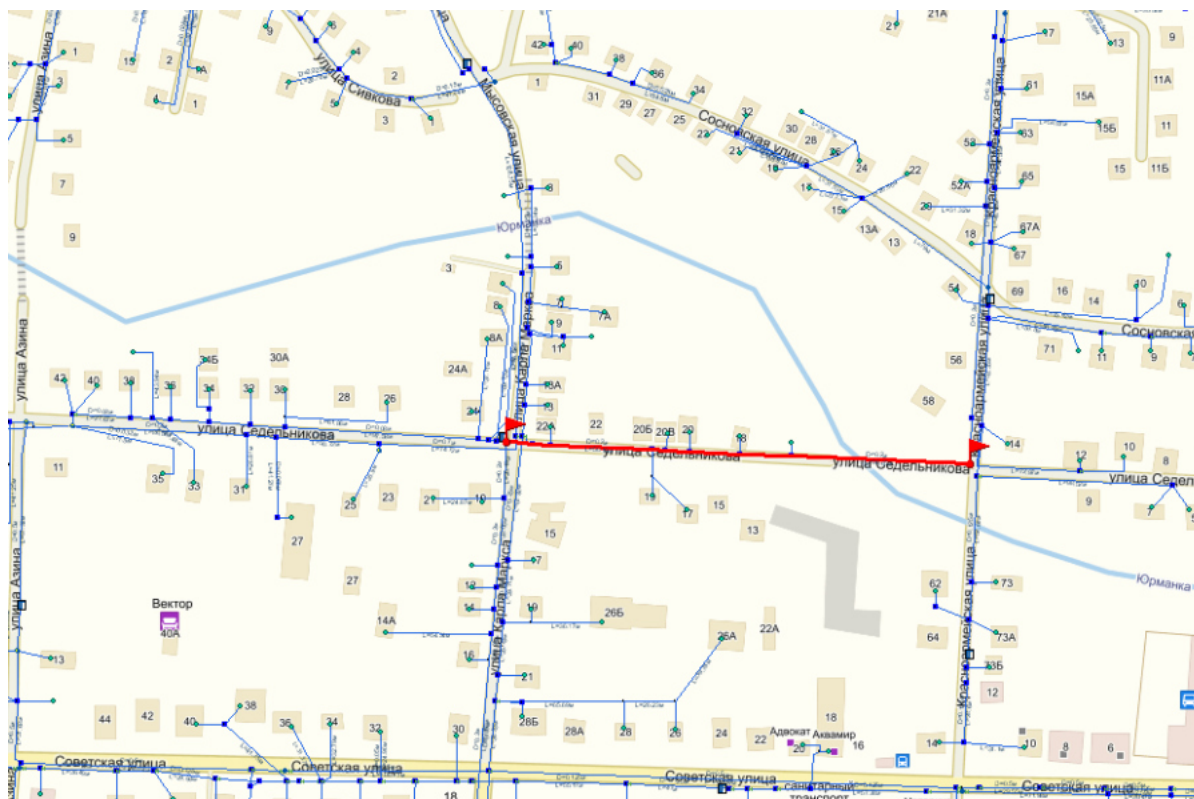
Участок водопроводной сети от Узел-5-2-80 до ПГ-138
